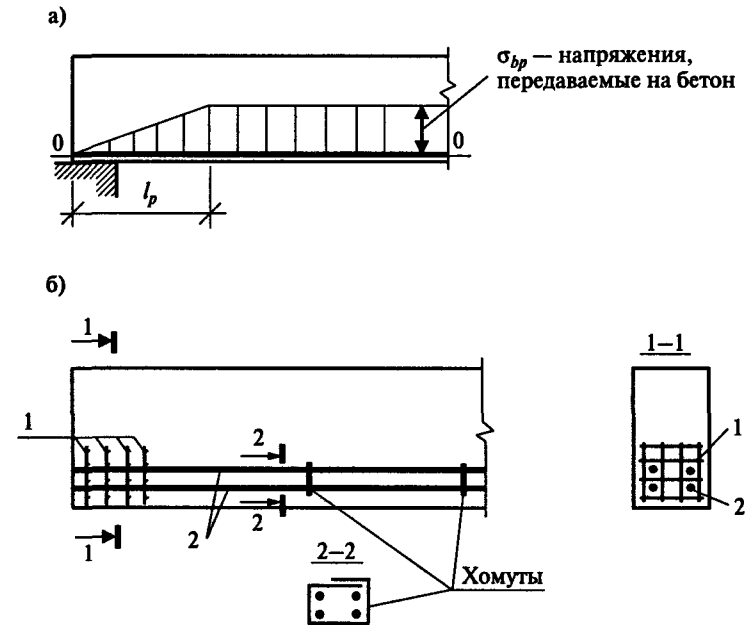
Армирование зоны передачи напряжений: а) длина зоны передачи напряжений; б) дополнительное армирование зоны передачи напряжений: 1 — арматурные сетки; 2 — предварительно напряженная арматура
